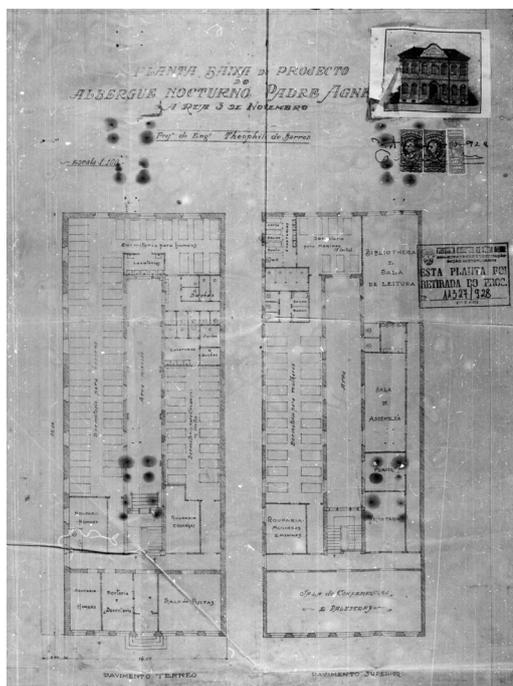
Albergue noturno Padre Agnello. Planta do pavimento térreo e pavimento superior.
